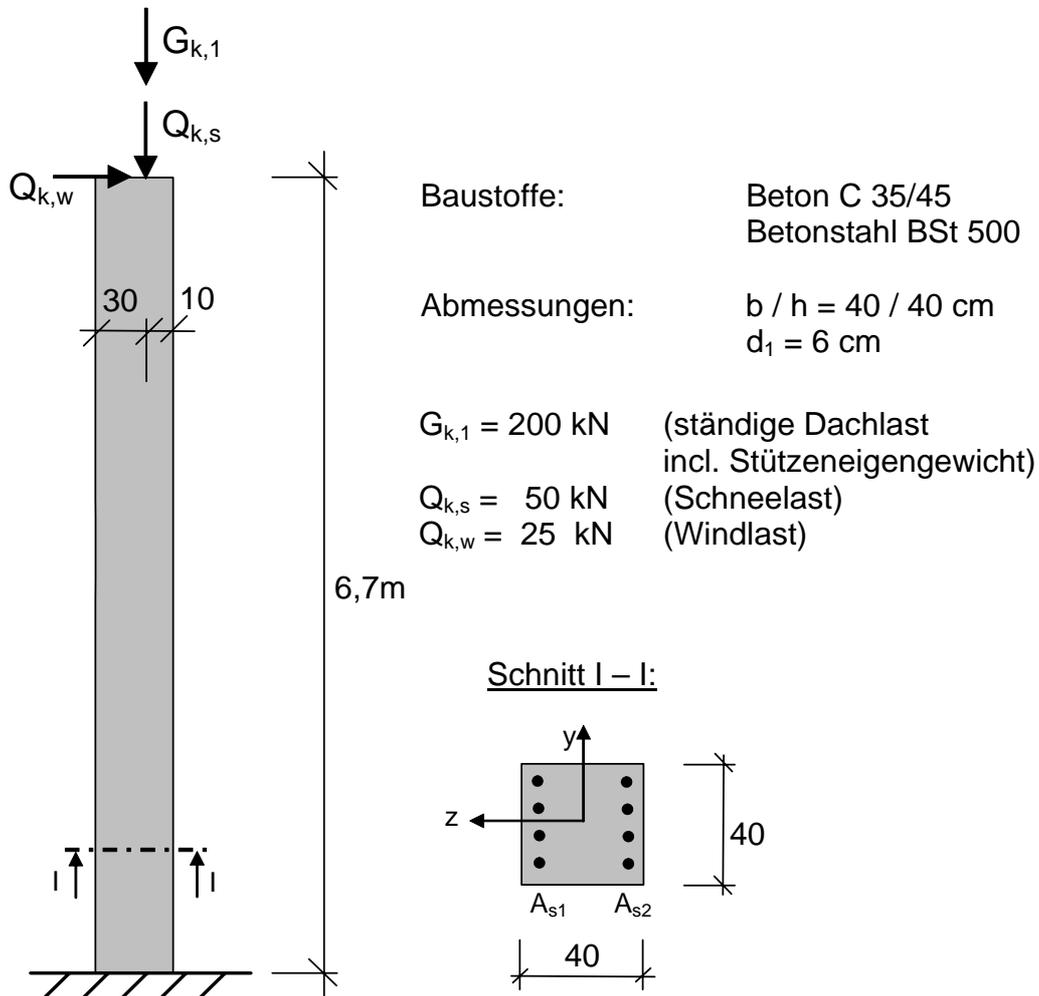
Stahlbetonstütze mit Einwirkungen und Systemabmessungen
